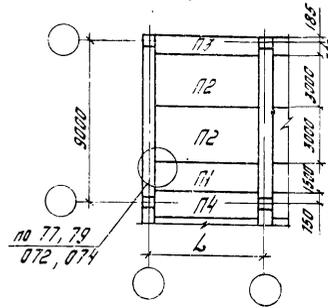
Типовые раскладки ребристых плит перекрытия и покрытия серии 1.042-1
